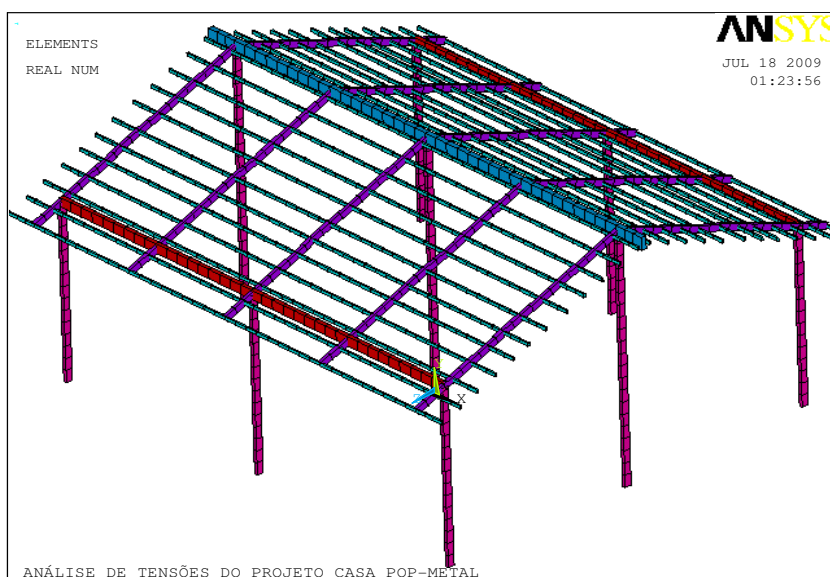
Perfis da estrutura metálica. Projeto POPMETAL.
